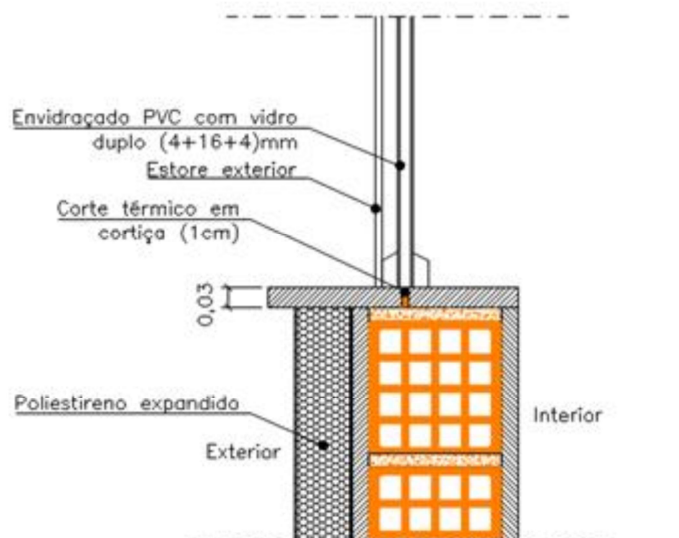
Pormenor construtivo parede com sistema ETICS, peitoril e vão envidraçado
